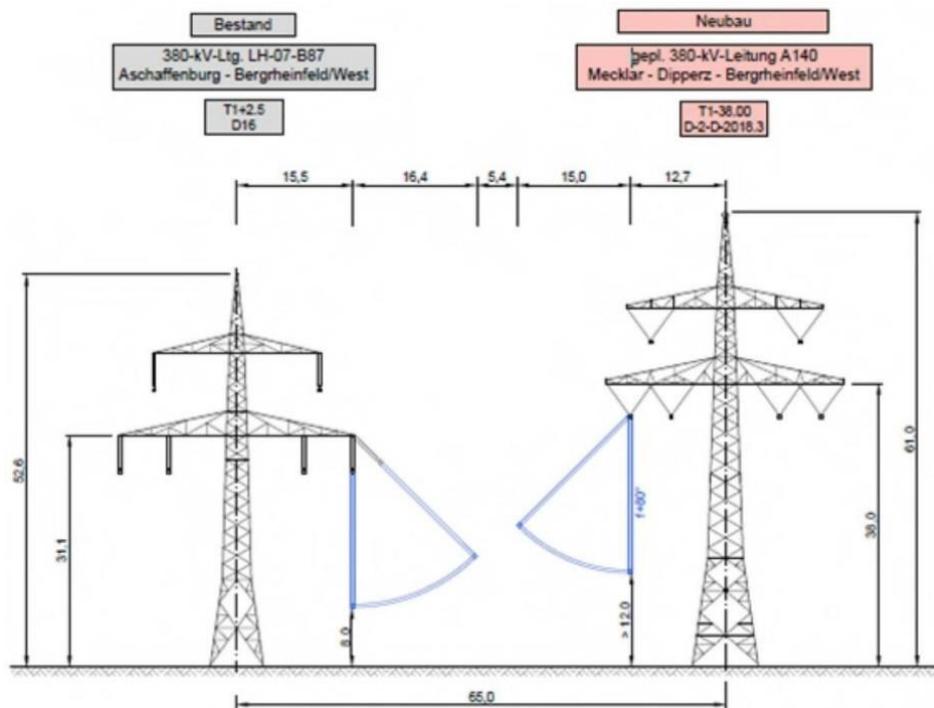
Parallelführung einer 380-kV-Neubautrasse neben der 380-kV-Bestandstrasse (alle Maße in m)
